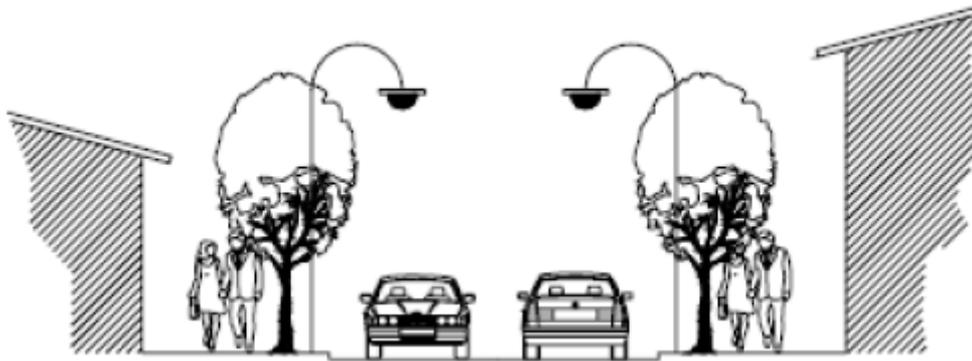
Ilustração do Perfil Transversal Tipo de uma Via de Acesso Local
